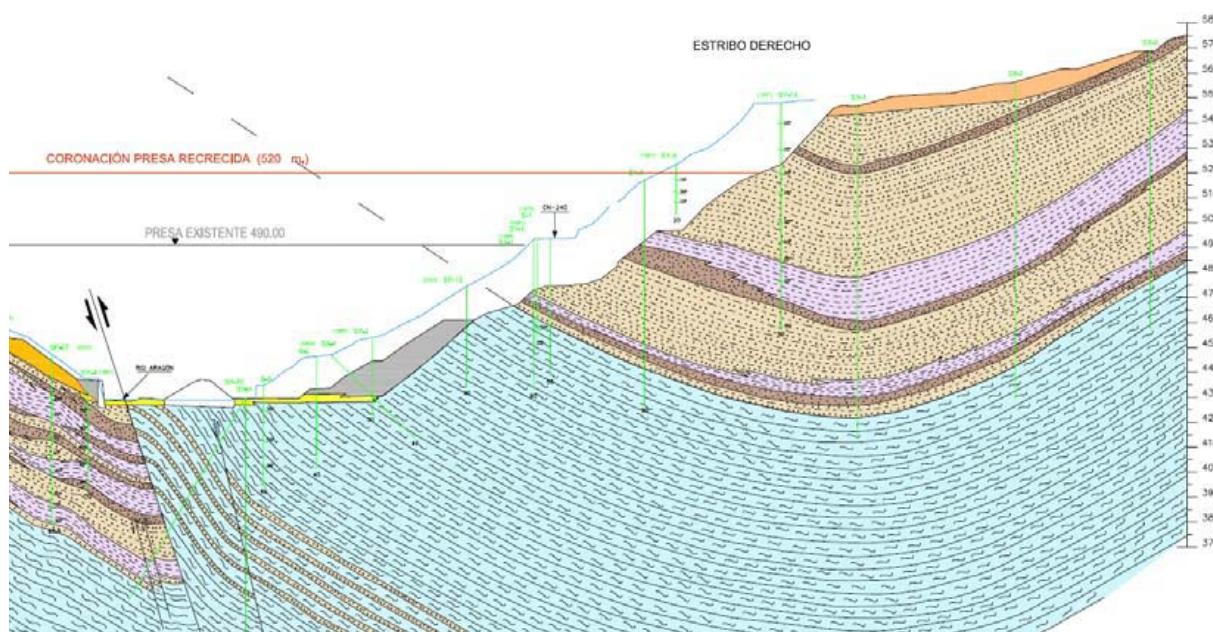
Corte geológico del sector norte de la cerrada reflejando la distribución y disposición de las Margas de Pamplona (azul claro) y el Flysch de Yesa (marrón y morado) en el eje de la presa proyectada. Fuente: Modificado nº3
